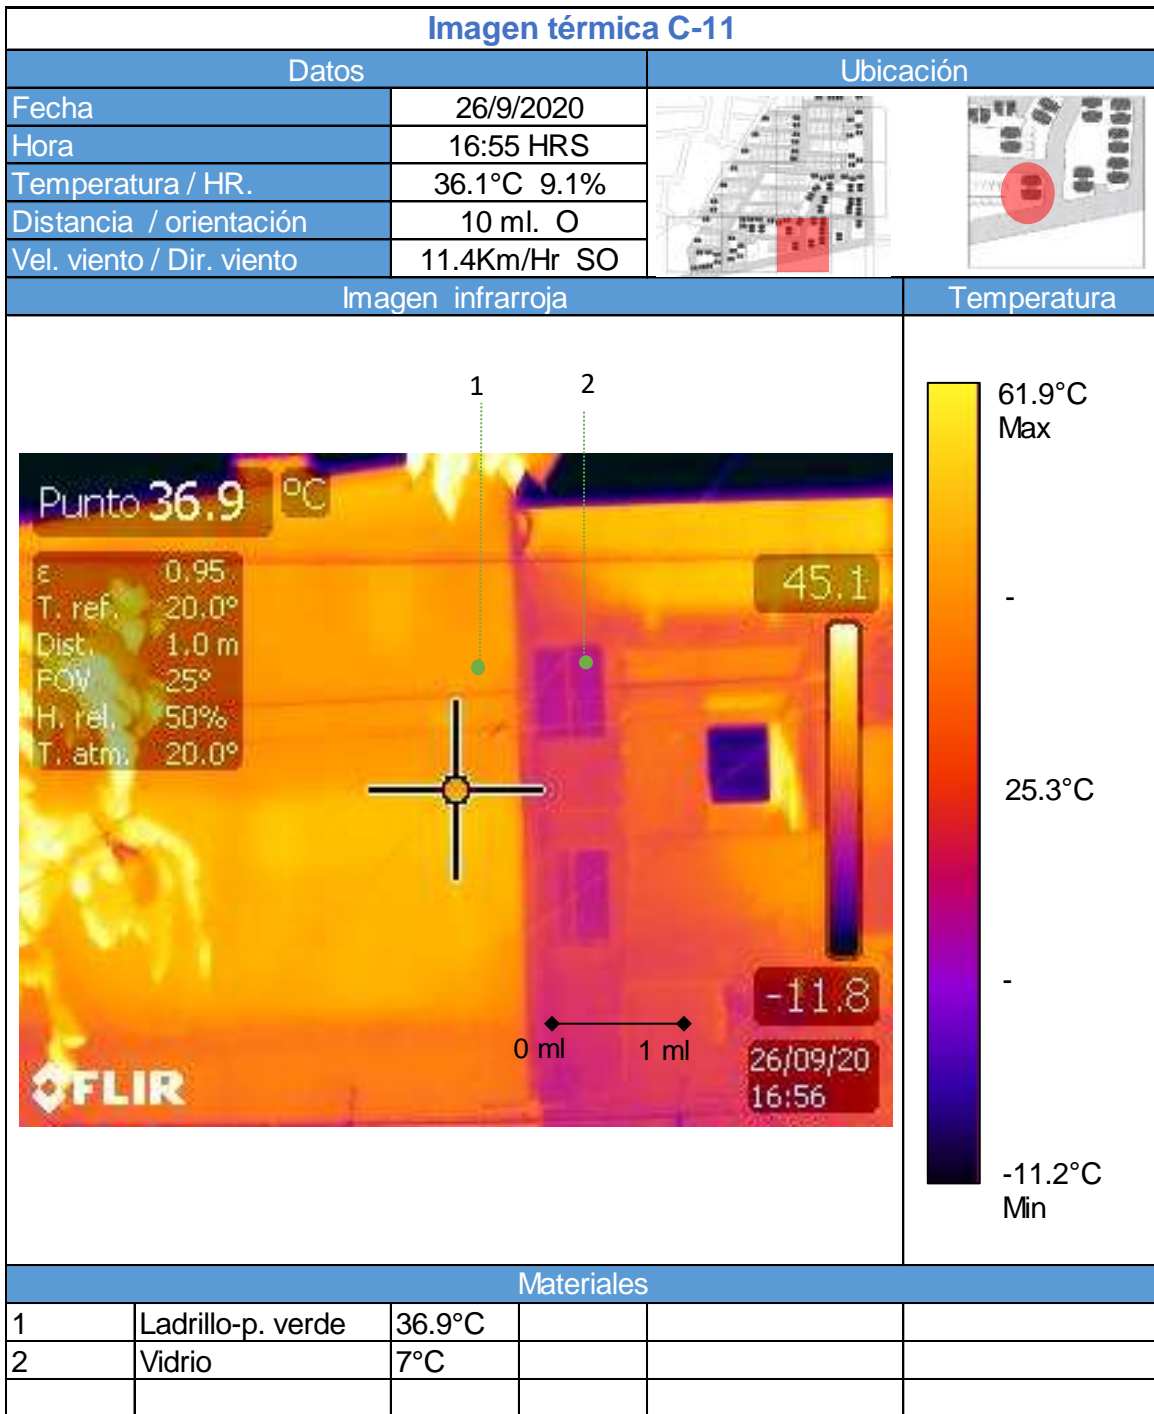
Ficha de imagen térmica C-11, con fachada al Este.
